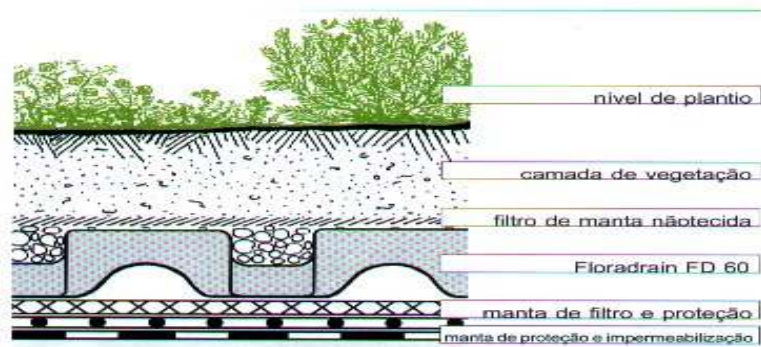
Estrutura do telhado verde (Fonte: Zinco, 2000)
